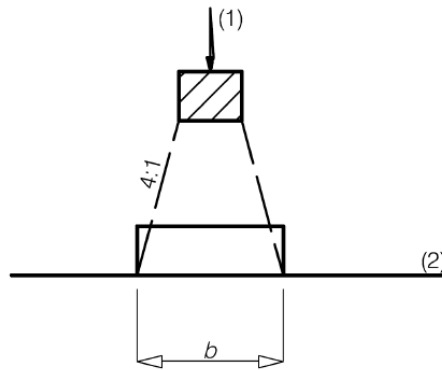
Distribuição longitudinal da carga pela travessa e pelo balastro.
